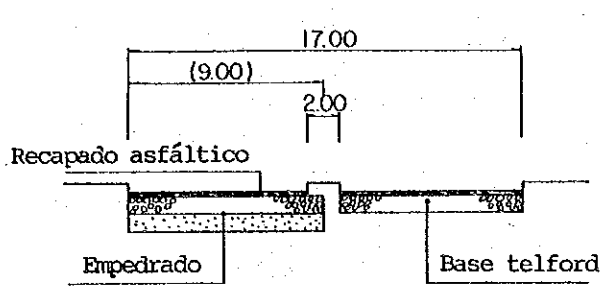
ESTADO DE PAVIMENTACION DE LA AV.R.DE FRANCIA
